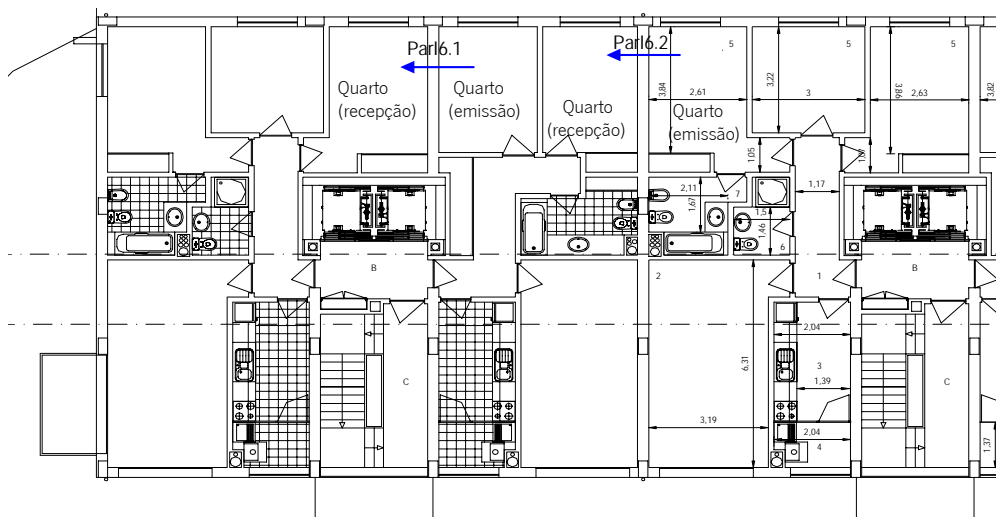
Planta do recinto emissor e do recinto receptor do ensaio de avaliação do isolamento da parede interior 6 – Parl6
